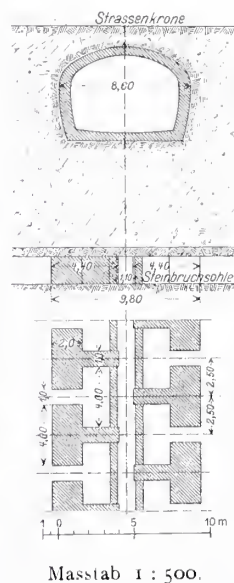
Sicherung des Baugrundes über einem Steinbruch.
